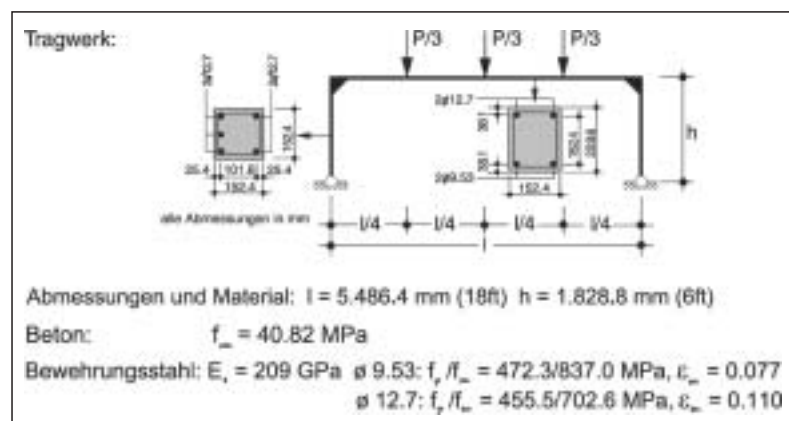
Stahlbeton-Testrahmen nach G. C. Ernst et al., ACI Journal 1973 (4), 261-269
